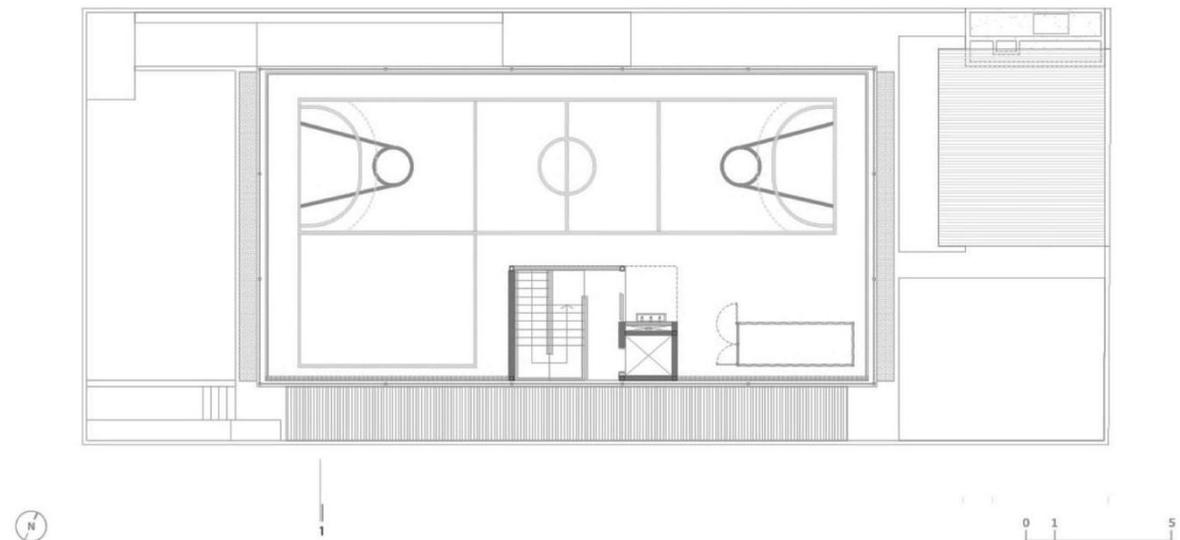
Planta Alta - Colegio en Altos Pinheiros.
